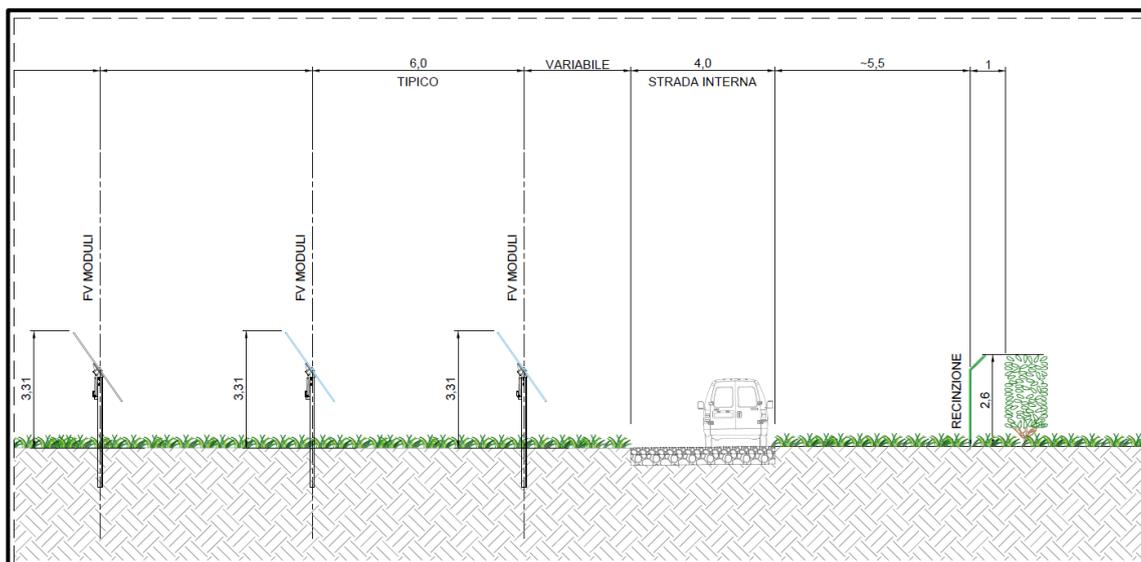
a Sezione tipo: piantumazioni nelle fasce perimetrali dell'area dell'impianto agrivoltaico (estratto da tavola AV.MAN.DE.AM.R.008, non in scala, le misure sono in metri).
